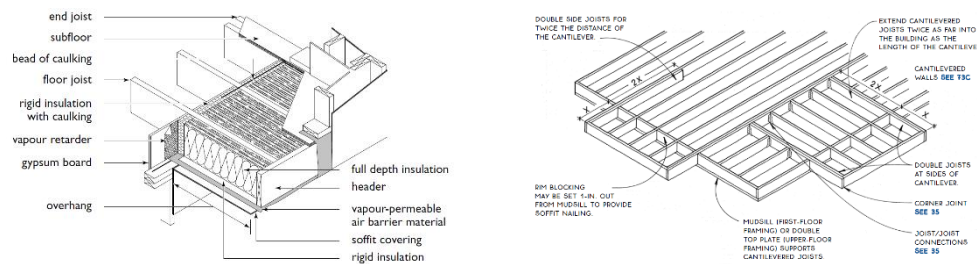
Projecções de pavimentos (CMHC, 2013a, p. 104) (Thalon, 2009).
